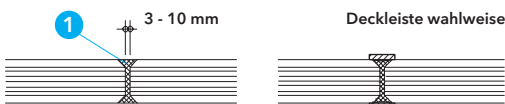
Detail B - Boden- /Deckenanschluss - Schnitt C-C
